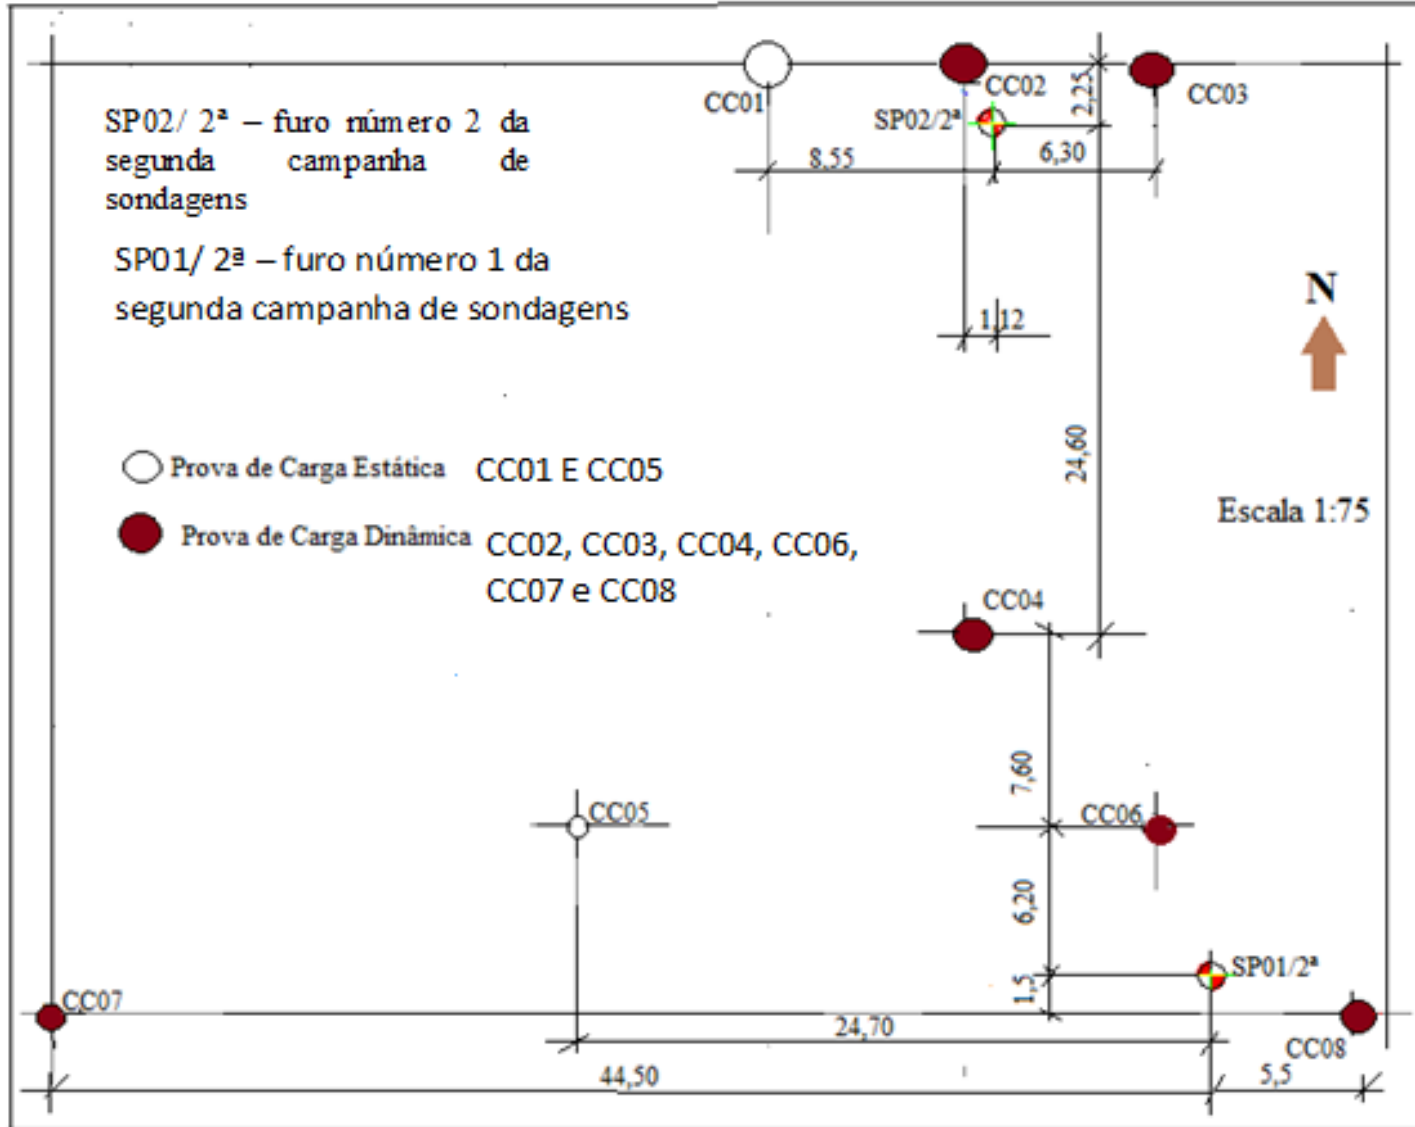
Locação dos ensaios no Edifício Centro de Convenções - Planta dos Pilares e Fundação Modificada
